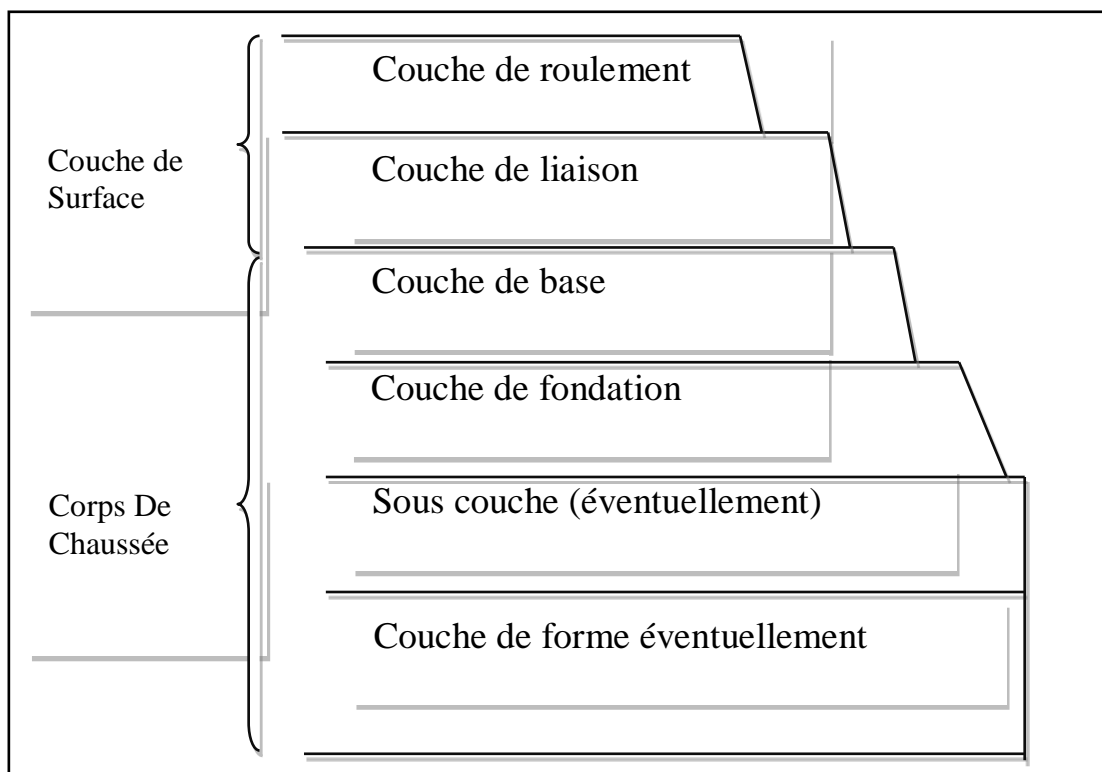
Coupes type d'une chaussée [DJABRI.A, HAMMANA.A]
